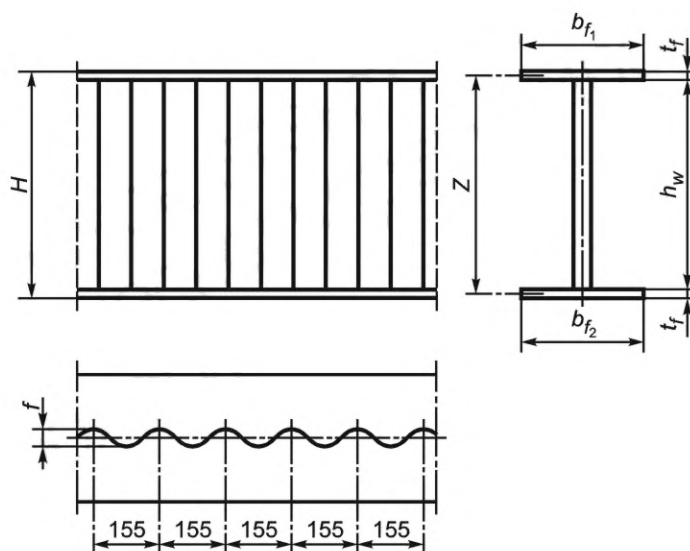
Общий вид сварного двутавра с синусоидальной поперечно-гофрированной стенкой и поясами из гнутых профилей
